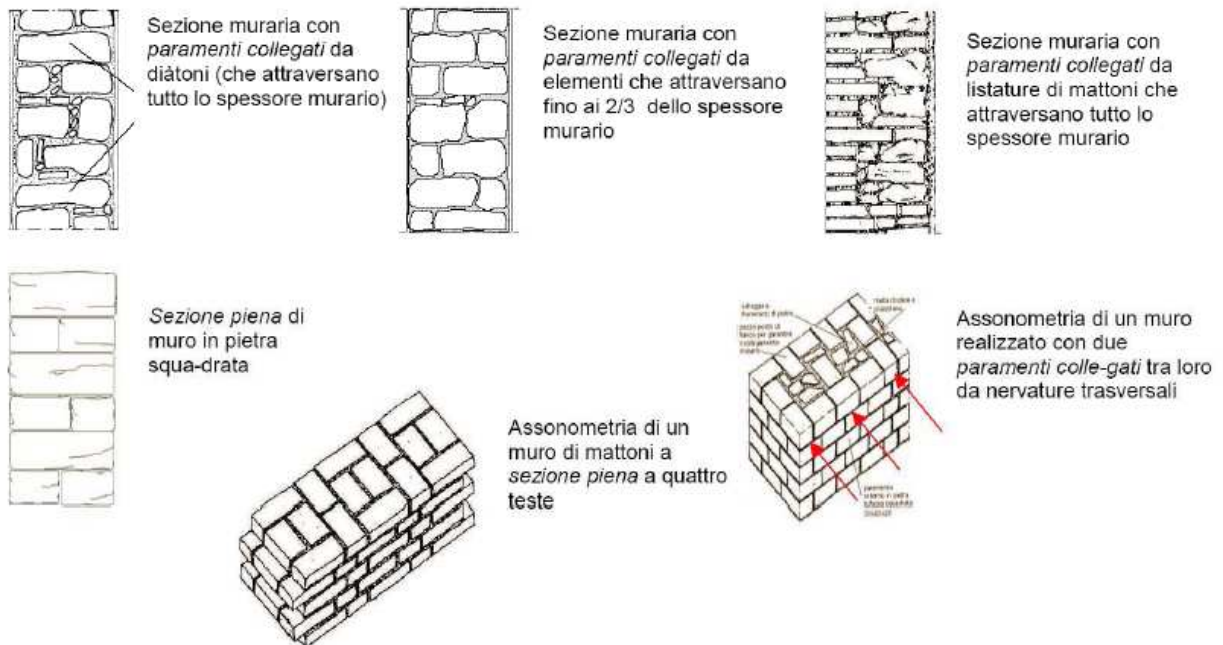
Pc: sezione a paramenti ben collegati o ad un unico paramento (sezione piena)
